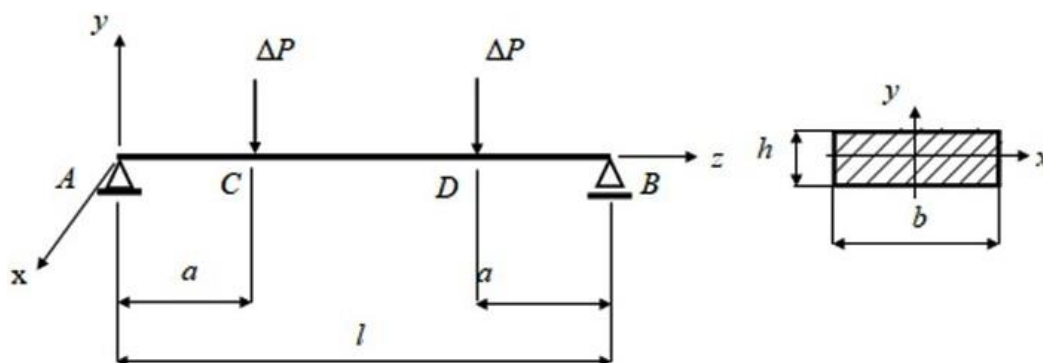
Расчетная схема испытываемой балки
